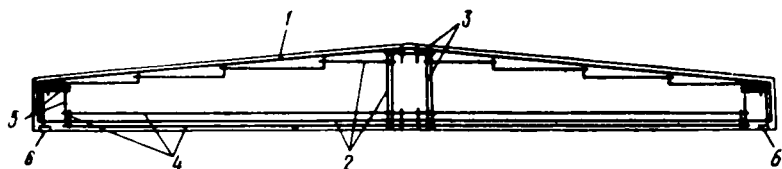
Схема армирования двускатных балок прямоугольными сварными сетками (вертикальные стержни сеток условно не показаны)
